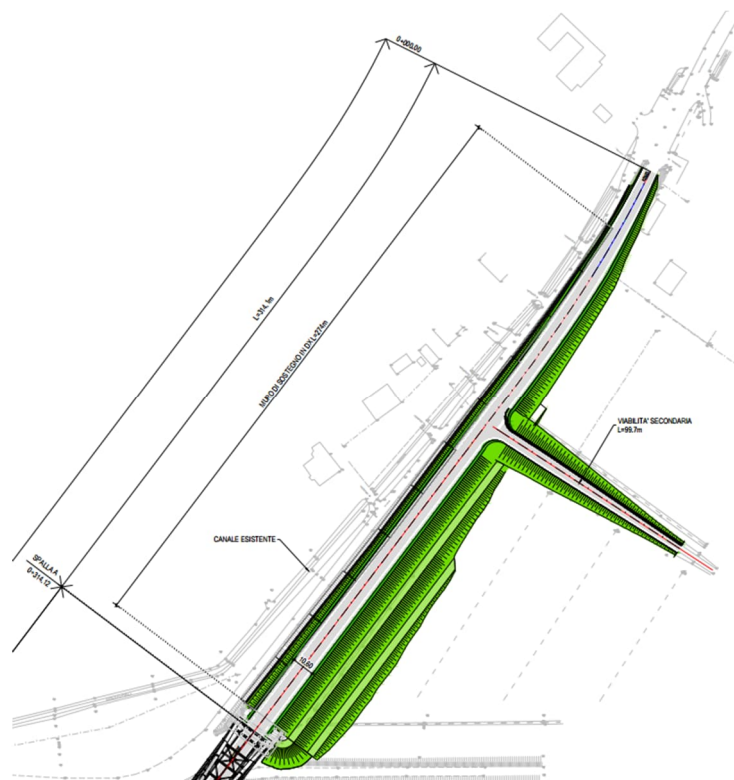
Stralcio planimetrico dell'approccio nord, con indicazione dell'estensione del muro di sostegno
